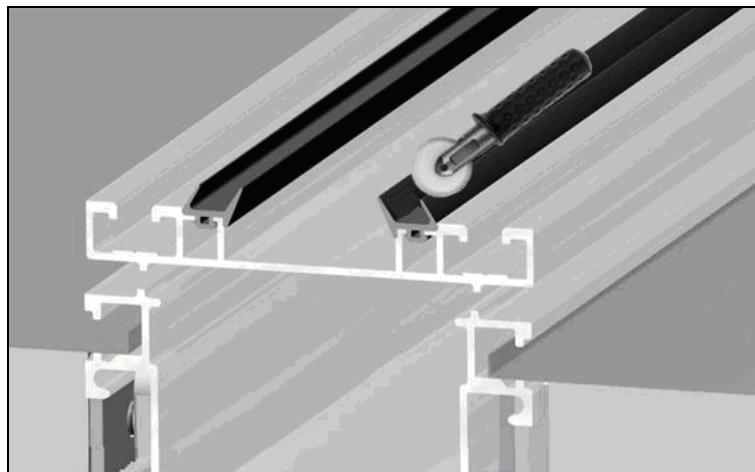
Schéma illustrant la mise en place des joints étanchéité modules
